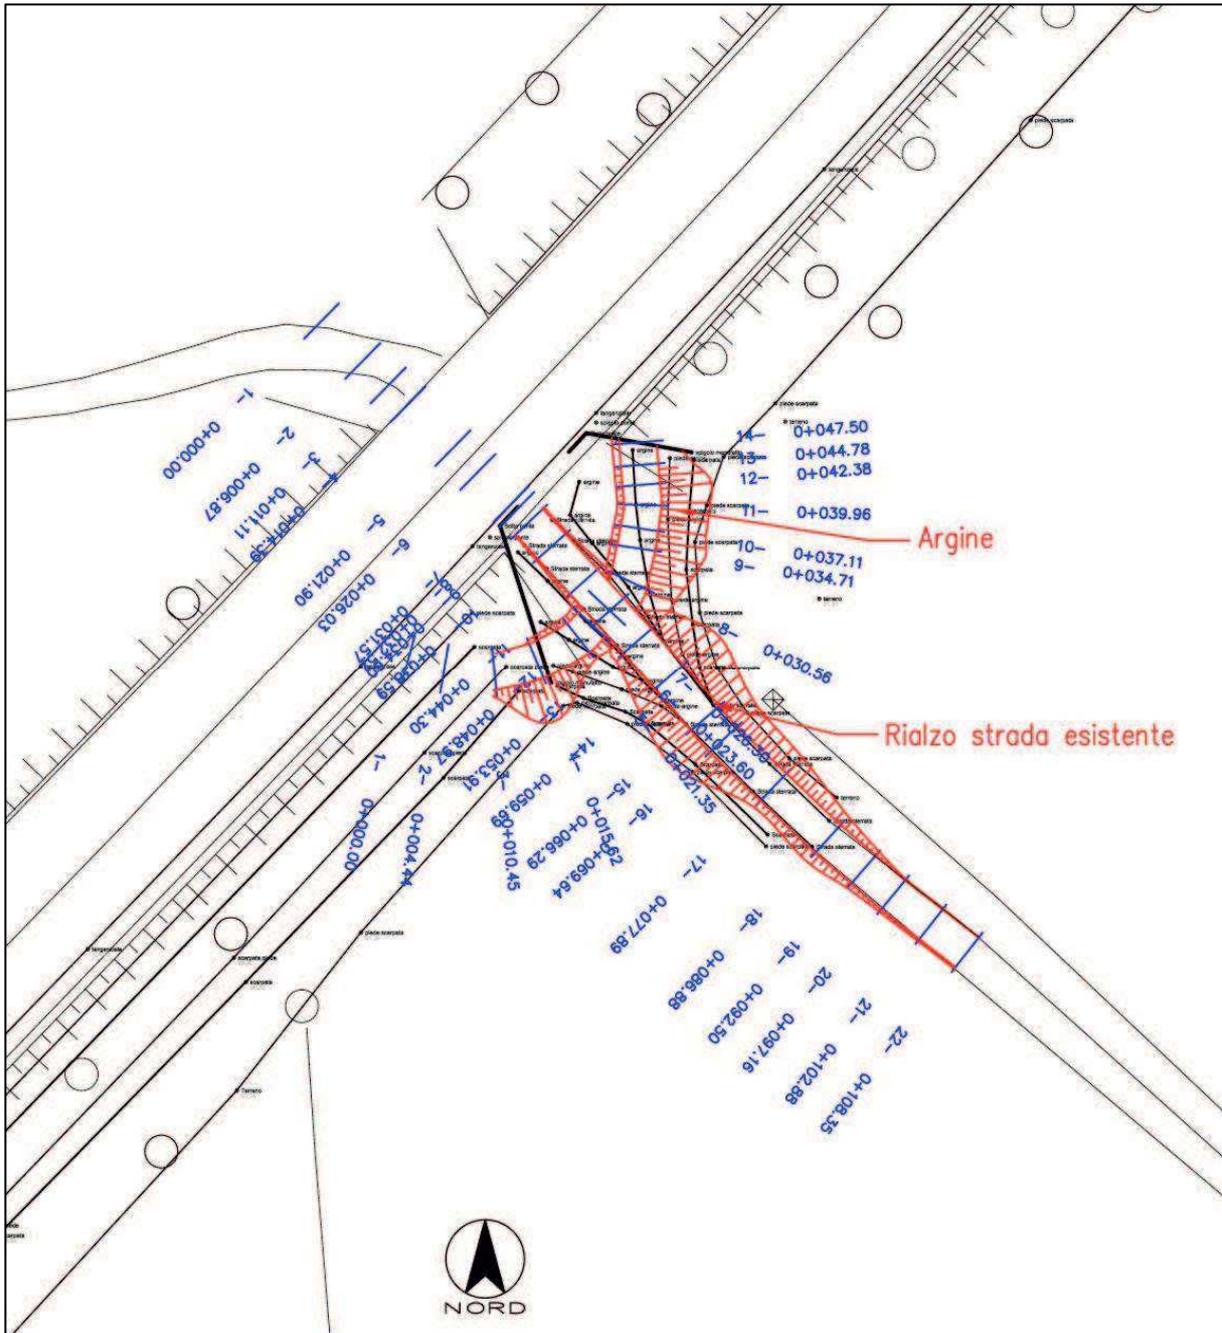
Arginatura chiusura fornice ramo nord Via del Chiozzetto – Planimetria
